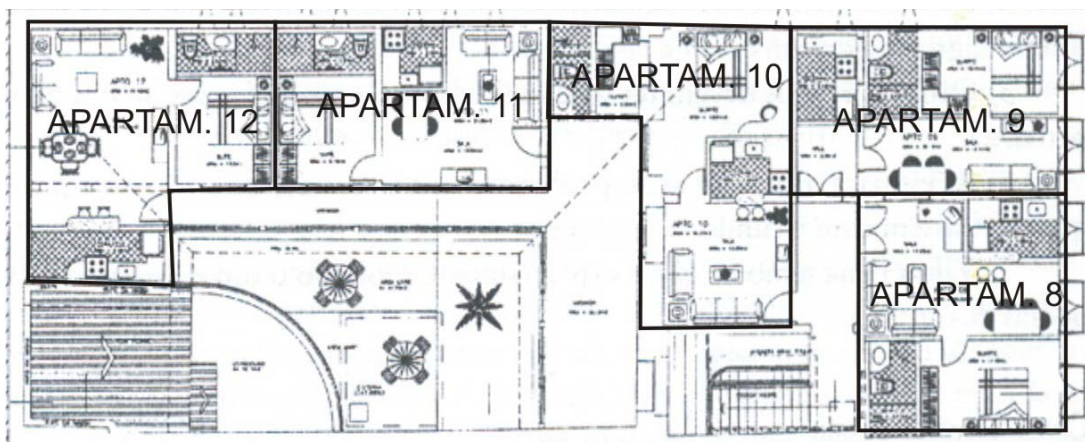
Sobrado à rua do Giz, 117 – Planta baixa do segundo pavimentos (LIMA et al, 2004, p. 130, adaptado pela autora).
